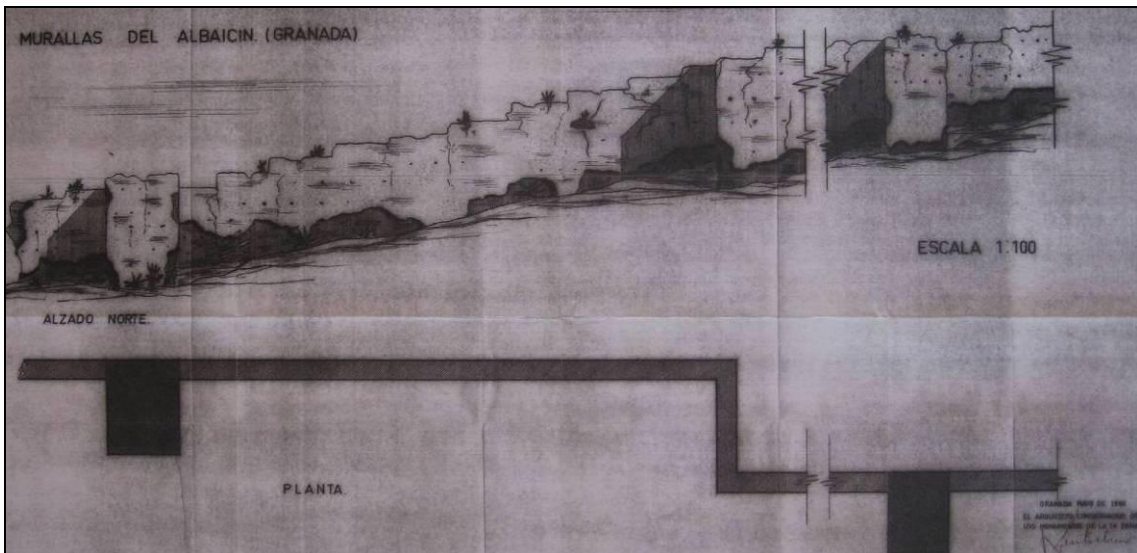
Prieto-Moreno. *Murallas del Albaicín*. Planta y alzado Norte (1960) AGA (Sección Cultura, 26/150)
